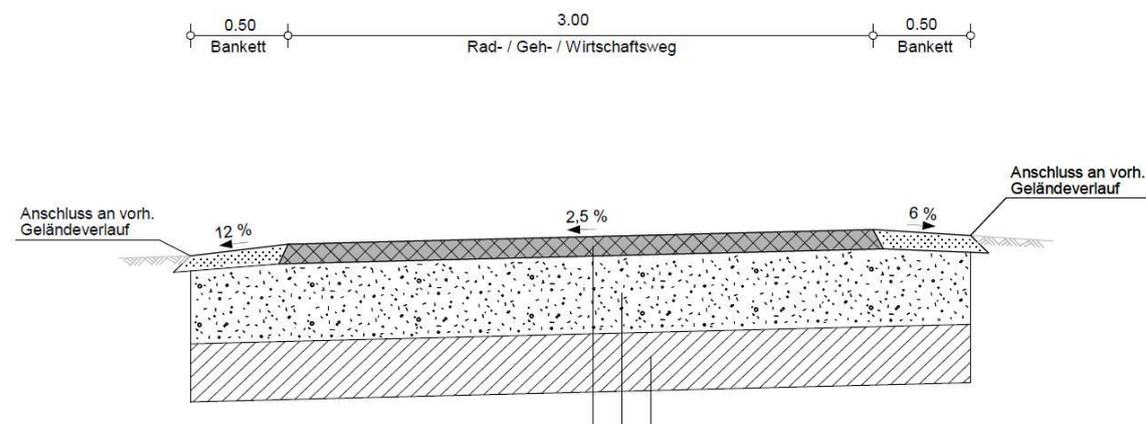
Regelquerschnitt eines kombinierten Rad- / Geh- / Wirtschaftswegs
